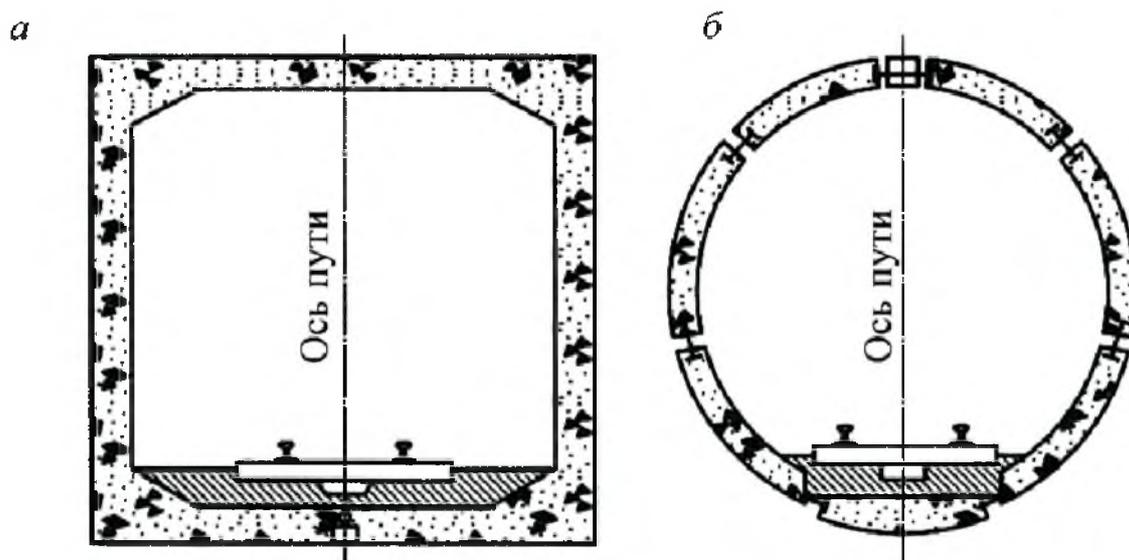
Поперечное сечение тоннеля, разработанного:
